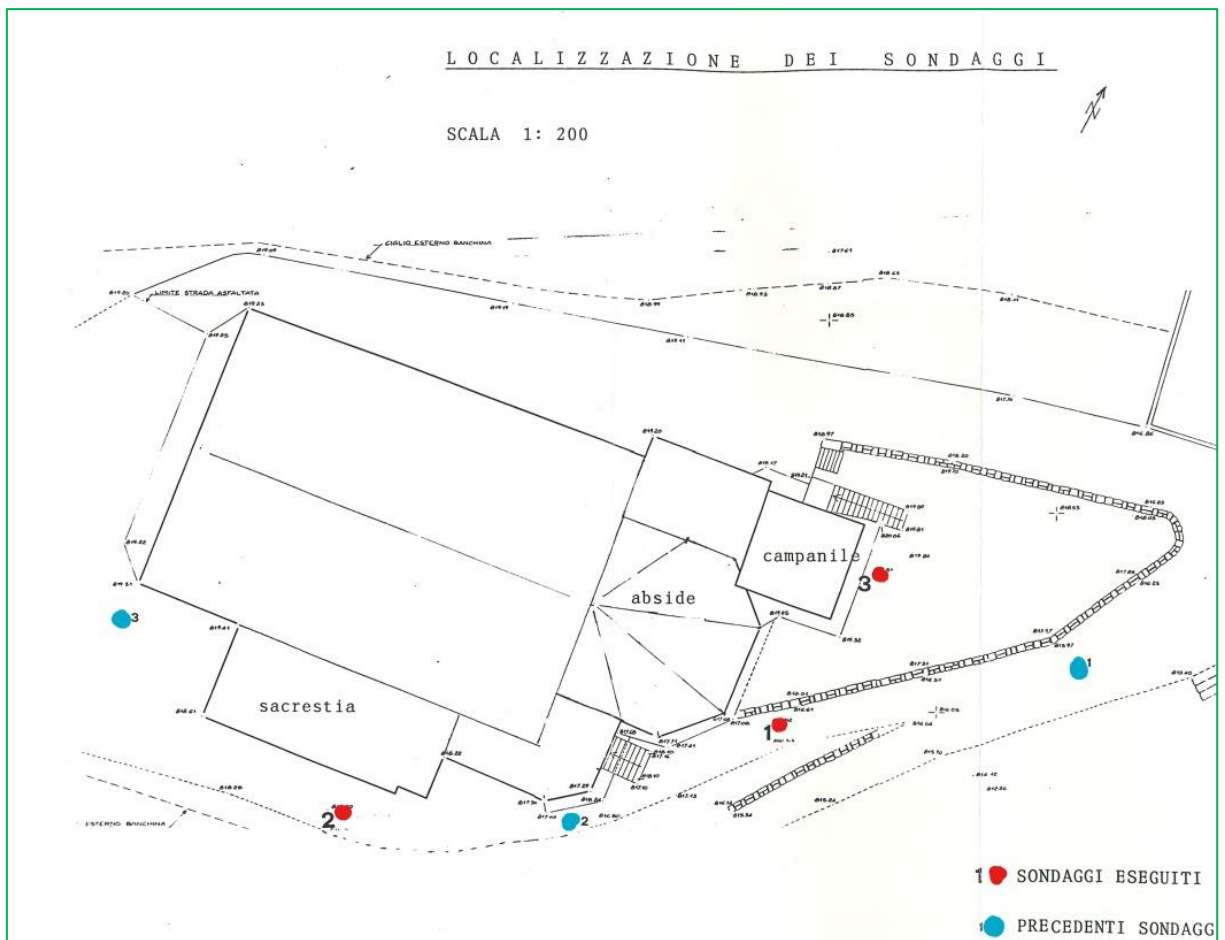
Posizione dei sondaggi estratta dall'allegato [2]
